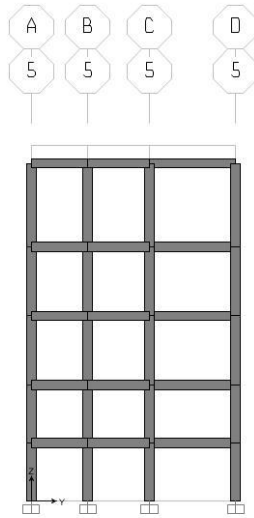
Elementos estructurales en el cuadrante “yz” sobre el eje “5”.
